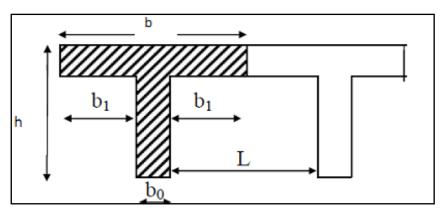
Section de la poutrelle après coulage de la dalle de compression
